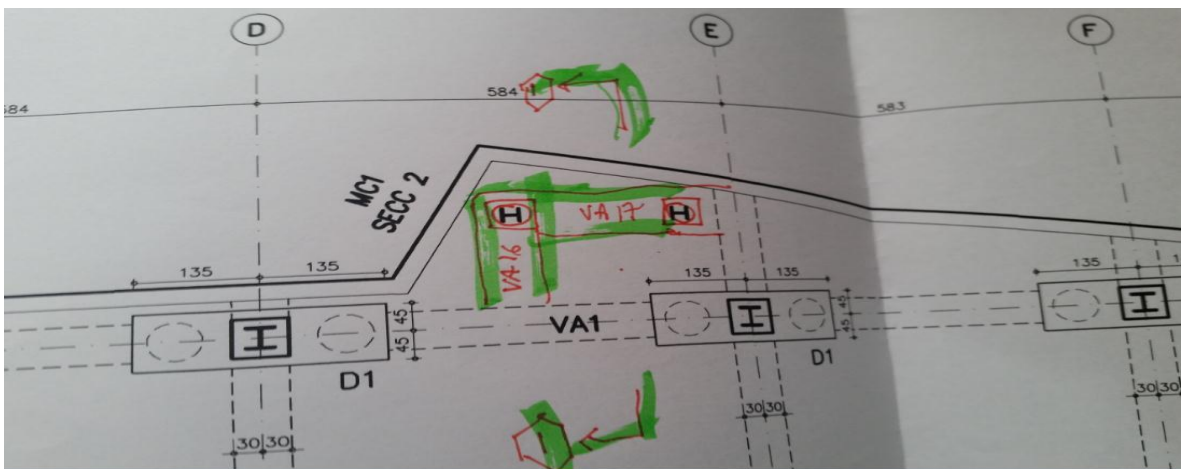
PLANTEAMIENTO INICIAL DE PLANTA DE CIMENTACIÓN.
